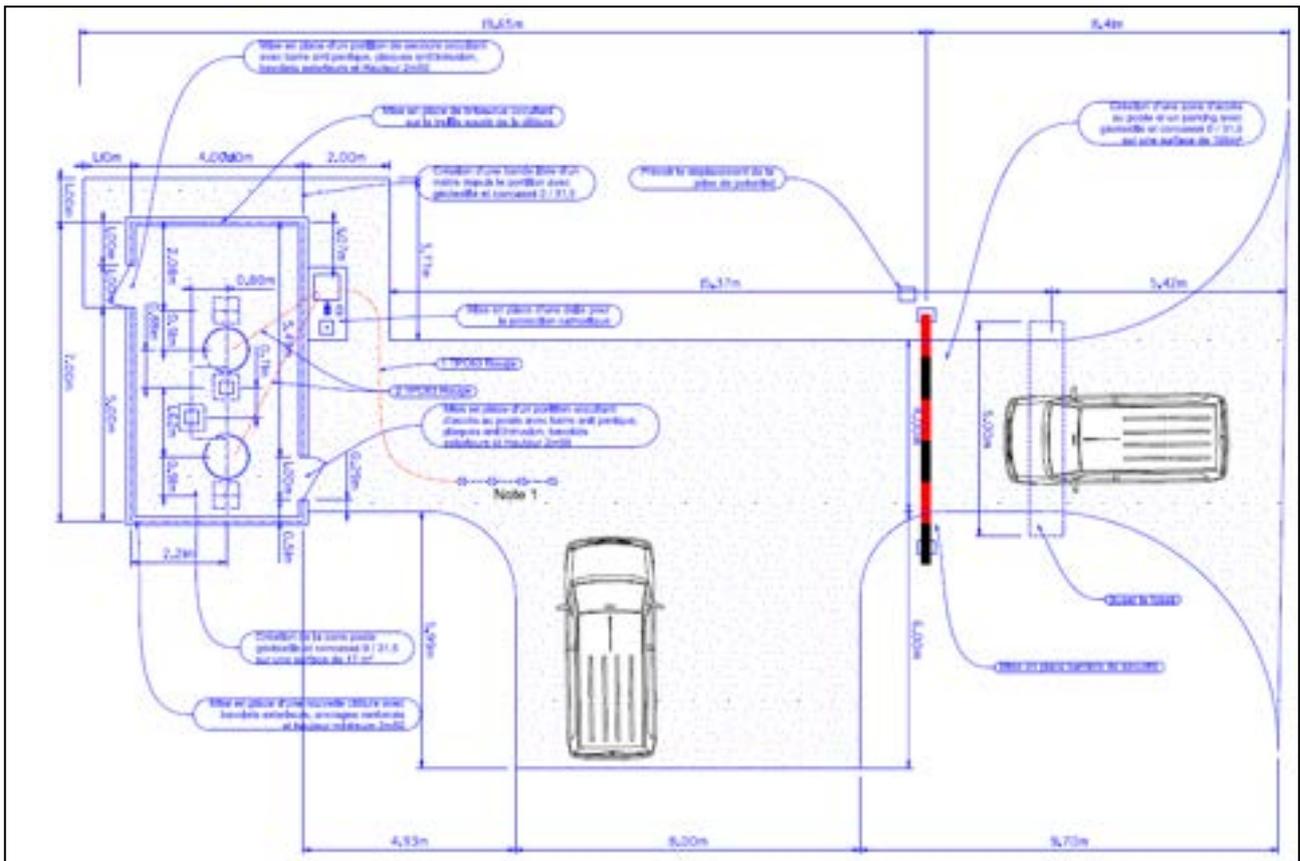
Poste de Sectionnement de Montauban ZI Parages projeté
